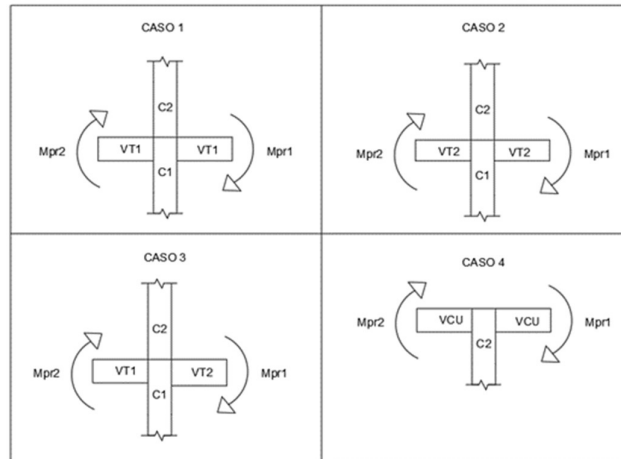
Casos de interacciones de viga-columna de la estructura (Boza y D´Steffano. 2023)
